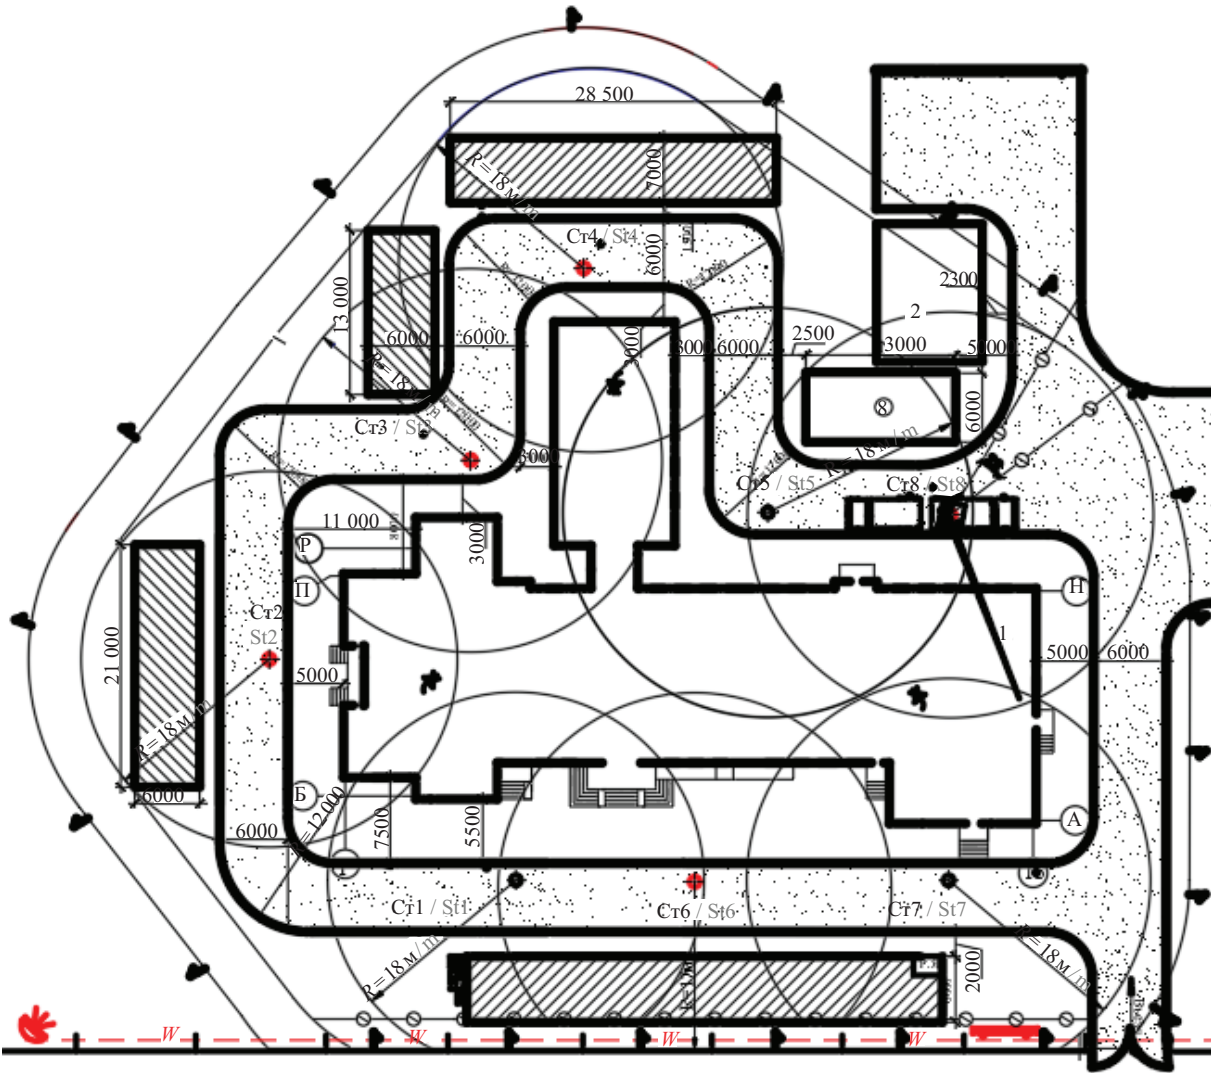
Фрагмент строительного генерального плана возведения школы самоходным краном KC-55729B
